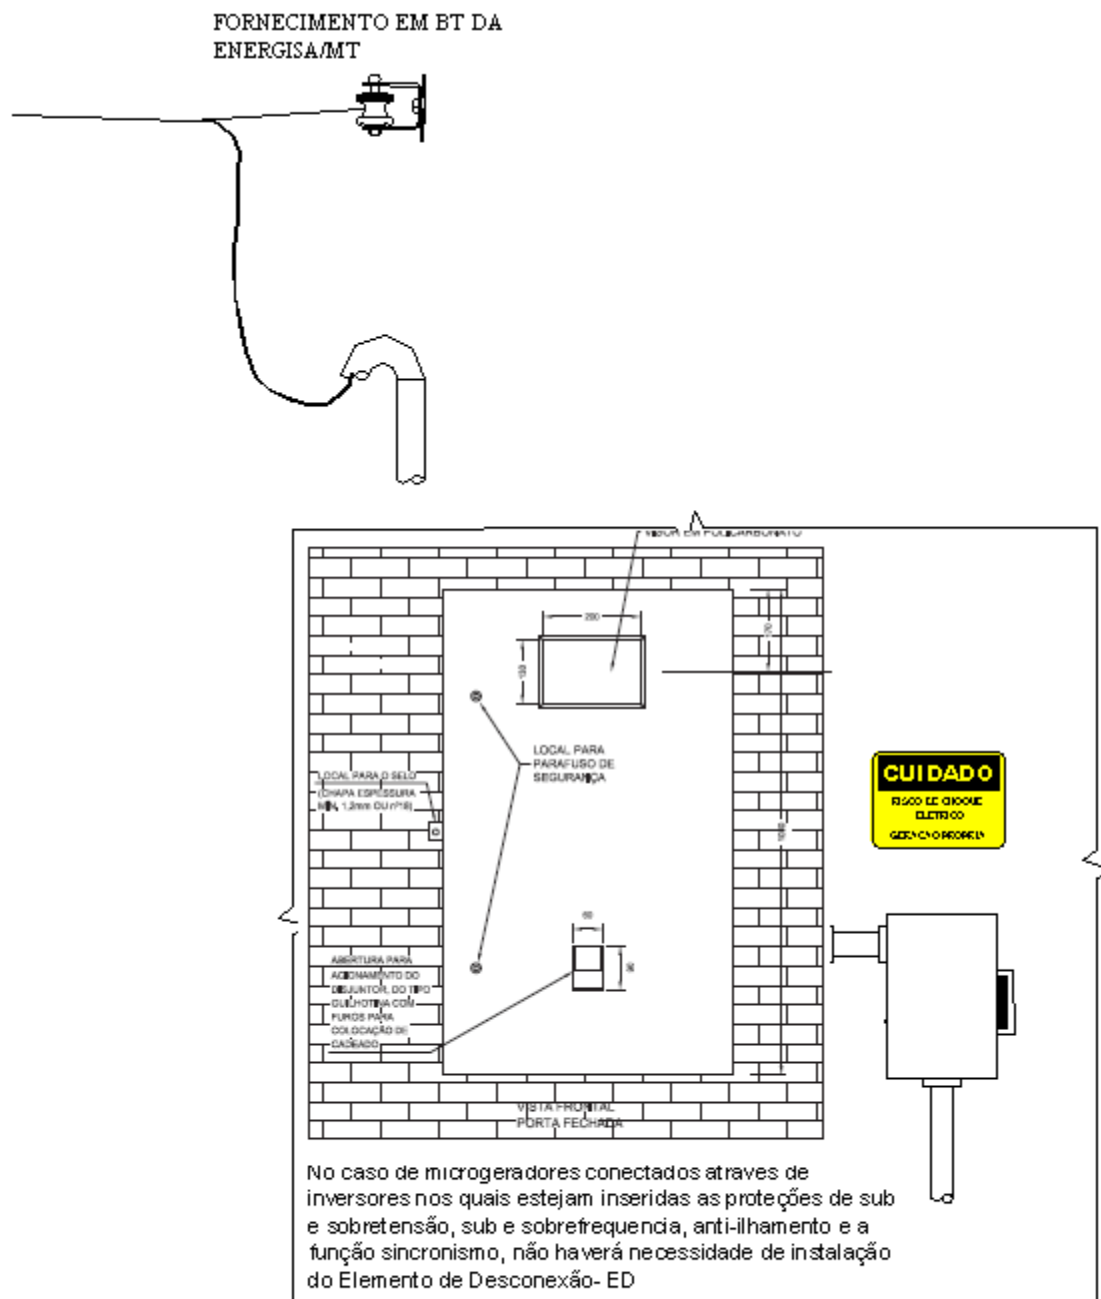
Disposição do Elemento de Desconexão - ED - instalado junto à medição e proteção no padrão de entrada em muro ou mureta - com medidor Bidirecional - 200 A
